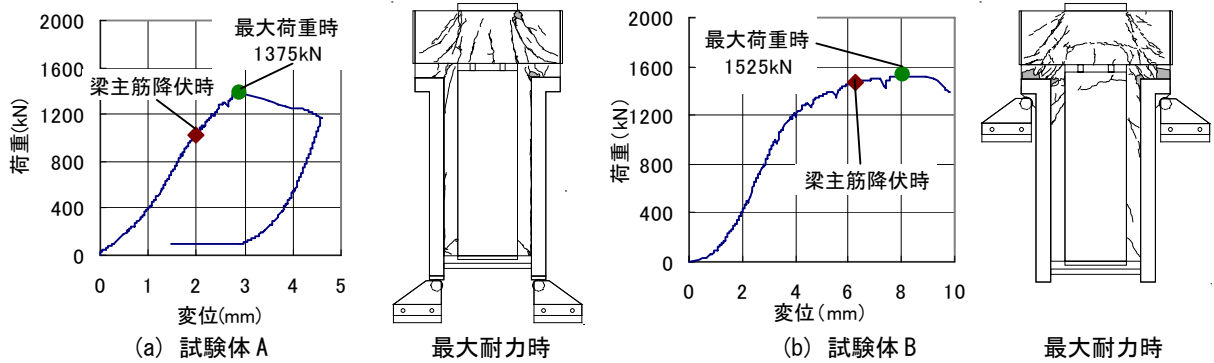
荷重-変位関係と最終ひび割れ状況 (実験2)
